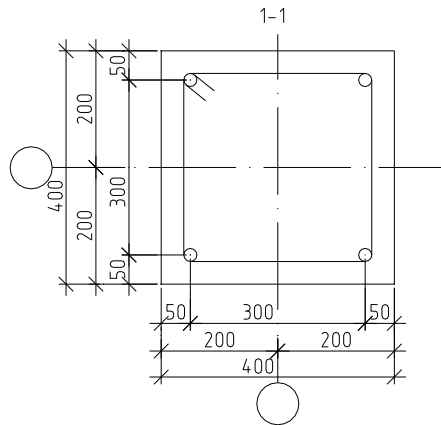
Схема армування колони К-2.2. Розріз 1-1
